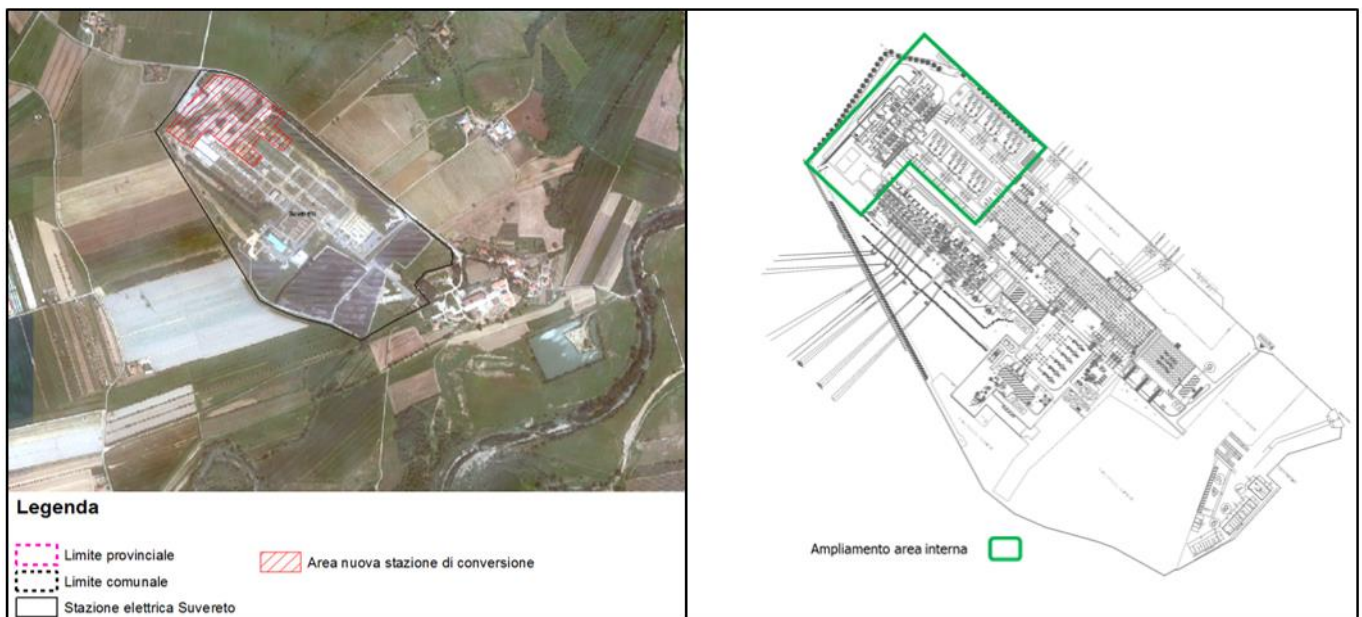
Intervento F - Stazione di conversione di Suvereto – interventi di progetto
